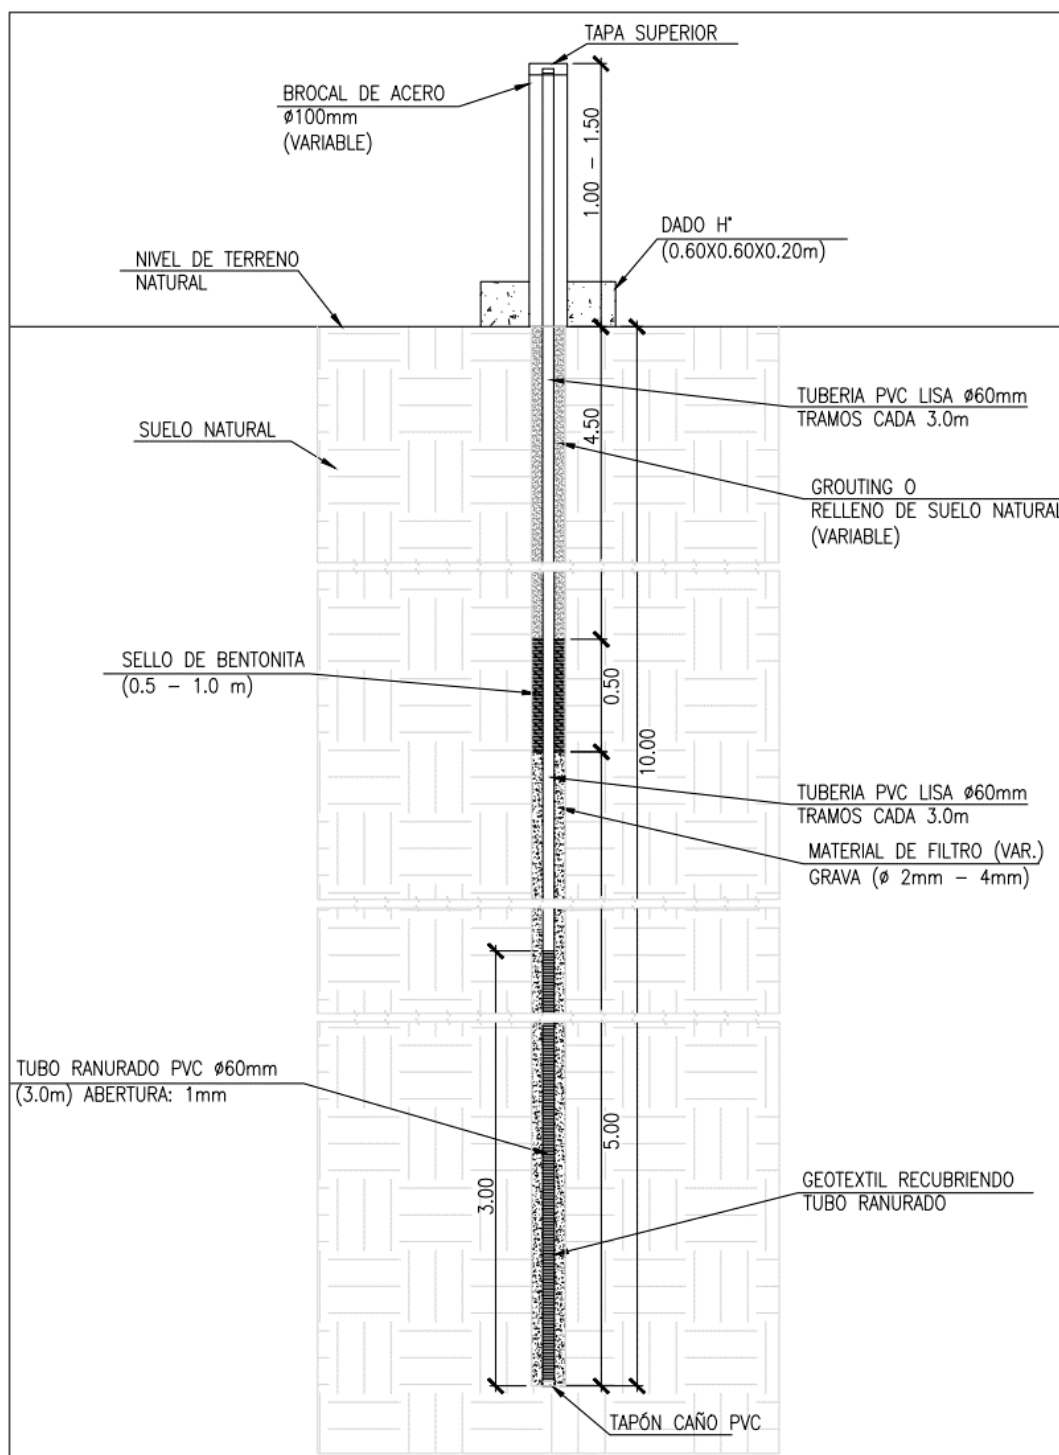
Esquema del piezómetro instalado en cada perforación
